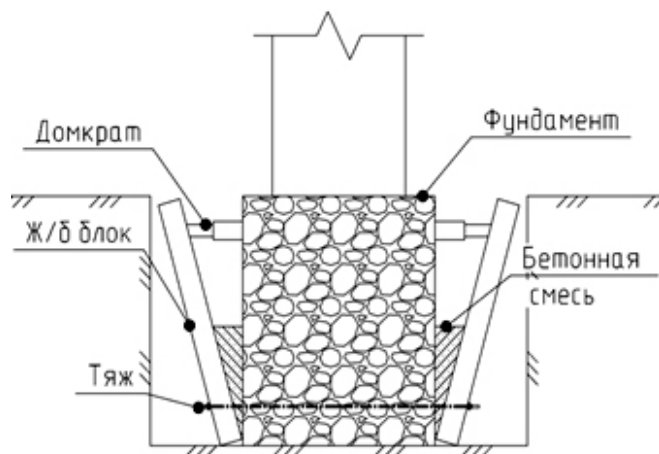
Усиление фундамента с помощью поворота железобетонных блоков
